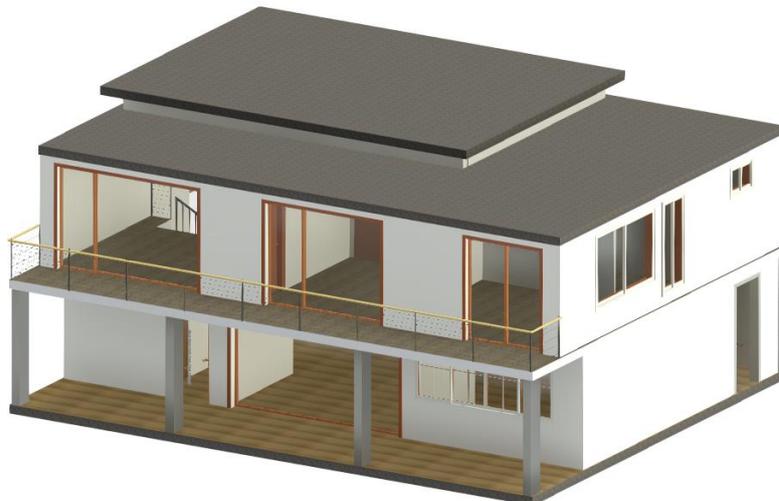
17 Modelado 3D: Fachada Posterior en Revit [Autores]
